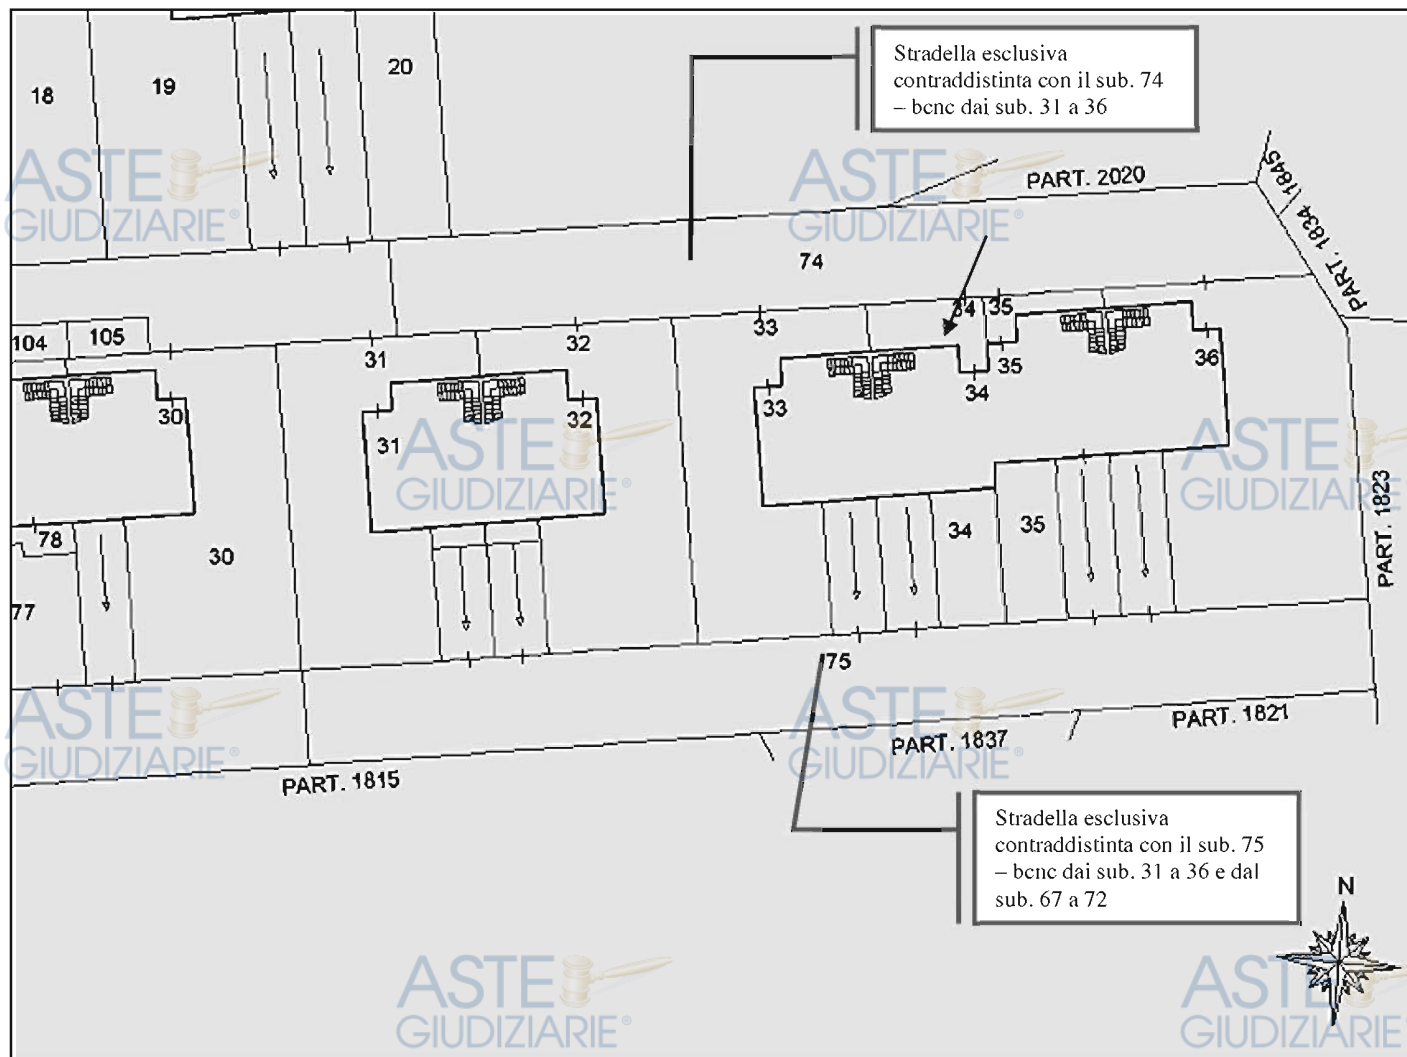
Visualizzazione dei beni oggetto della presente sezione- piano terra
